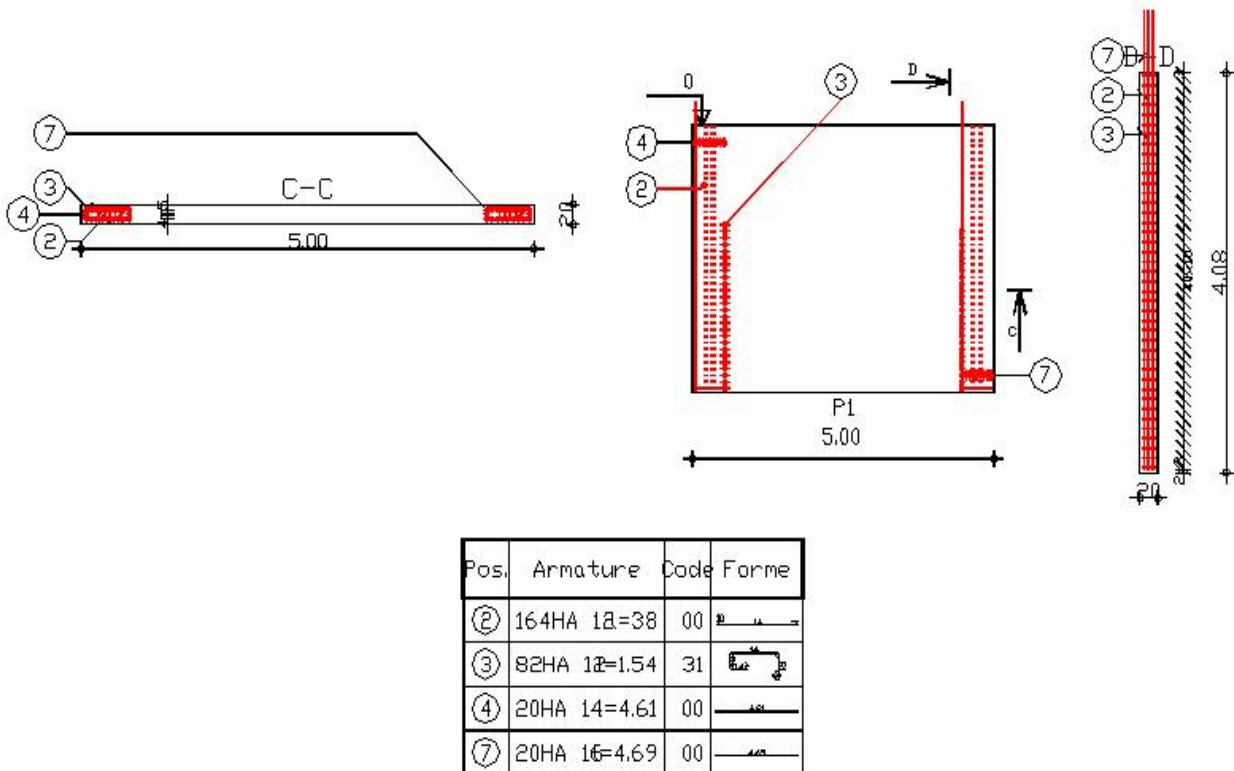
ferrailage de voile 20 cm coupe (C-C) et (D-D)
